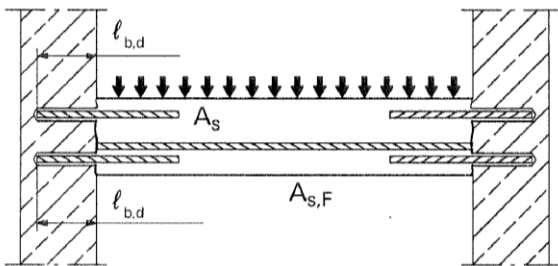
Bewehrungsanschlüsse überwiegend auf Druck beanspruchter Bauteile
